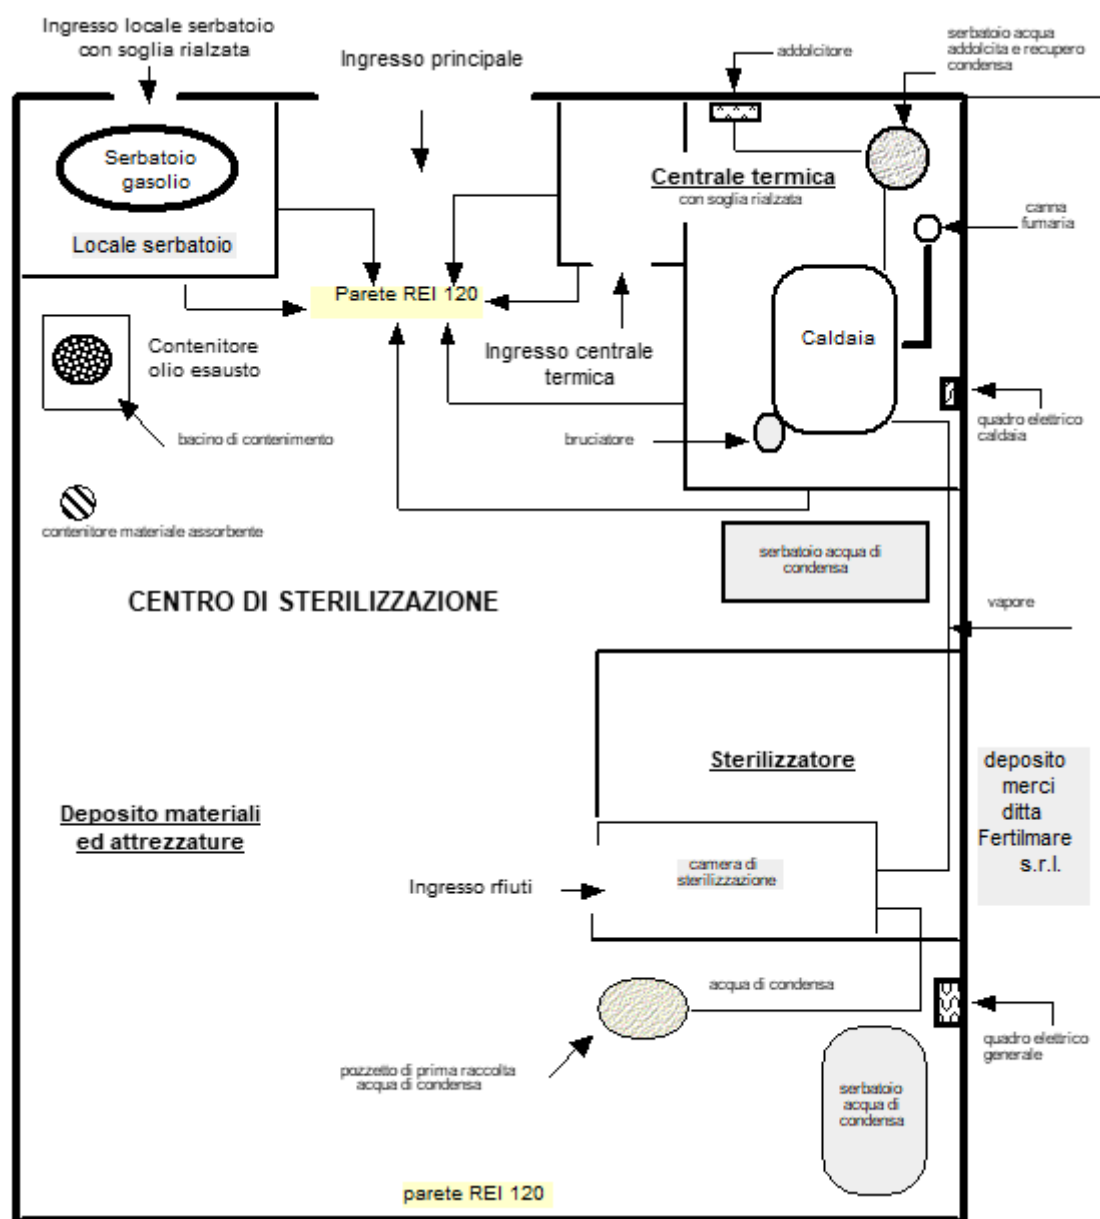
Planimetria dell'impianto Simap di via D'Alaggio
